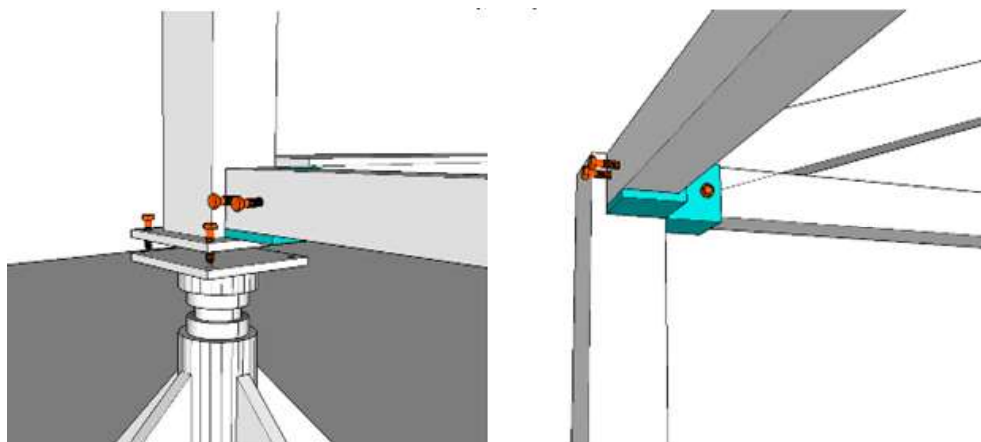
Estrutura do módulo de abrijo pilares vigas de travamento
